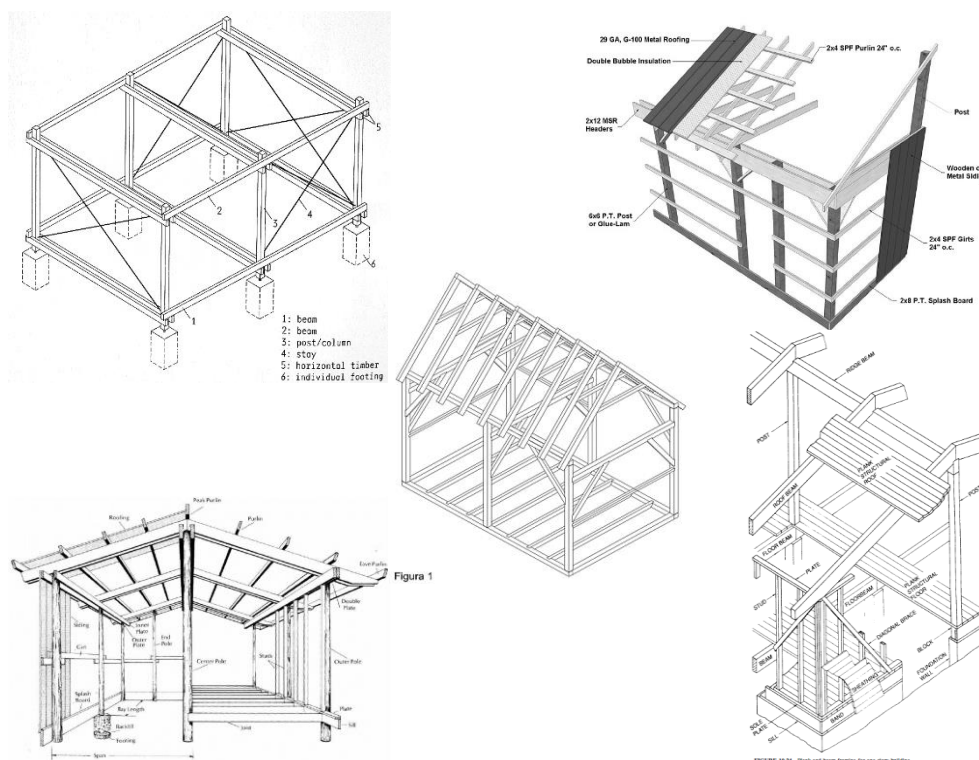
Vários tipos de porticados: de pórticos paralelos, tradicionais "timber frame", de estacas "pole construction", de postes verticais "post frame" e tipo "plank and beam" (Steiger, 2007) (Peraza Sánchez, et al., 1995) (Wolfe, 2008) (<http://www.barntoolbox.com/images/Post-Frame-lr.jpg>) (Merrit & Ricketts, 2000).
